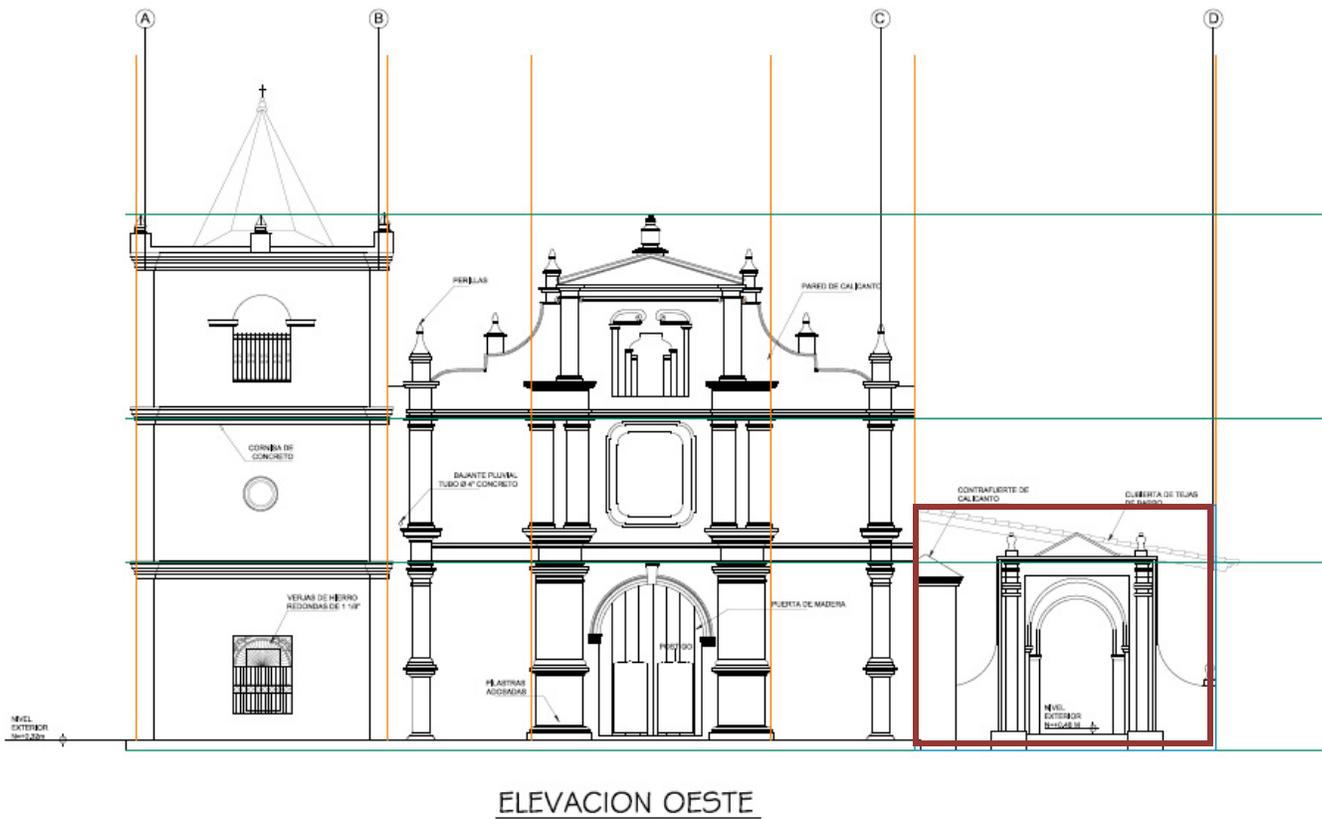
Calles y cuerpos en fachada. Autor: Grupo de trabajo.
